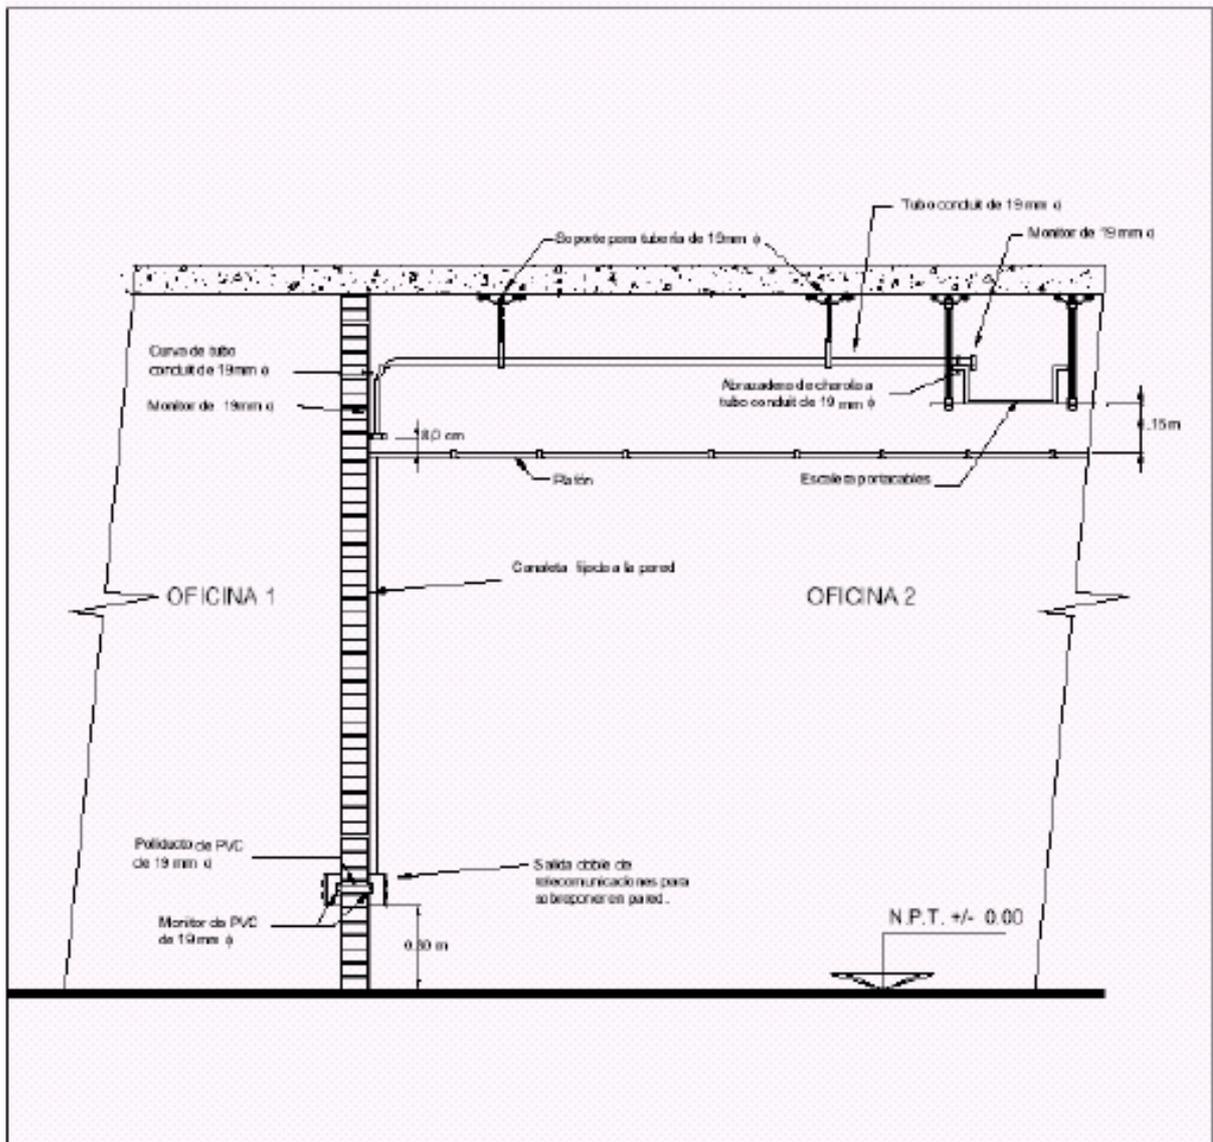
Detalle 1 Accesorios de escalera porta cables
